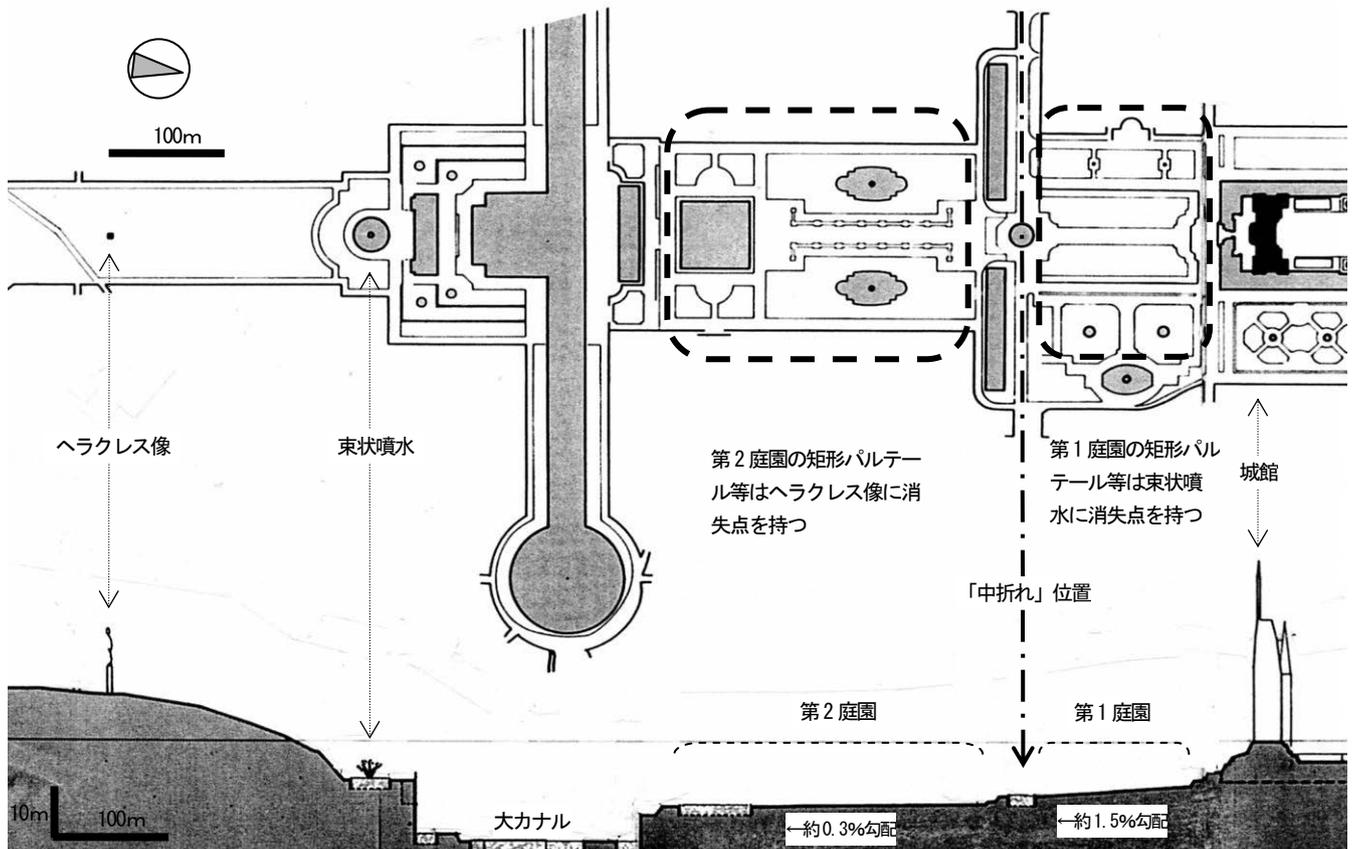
平面図(上) 縦断面図(下)²⁸⁾ 第1・2庭園部分とパースペクティブ消失点の位置関係
